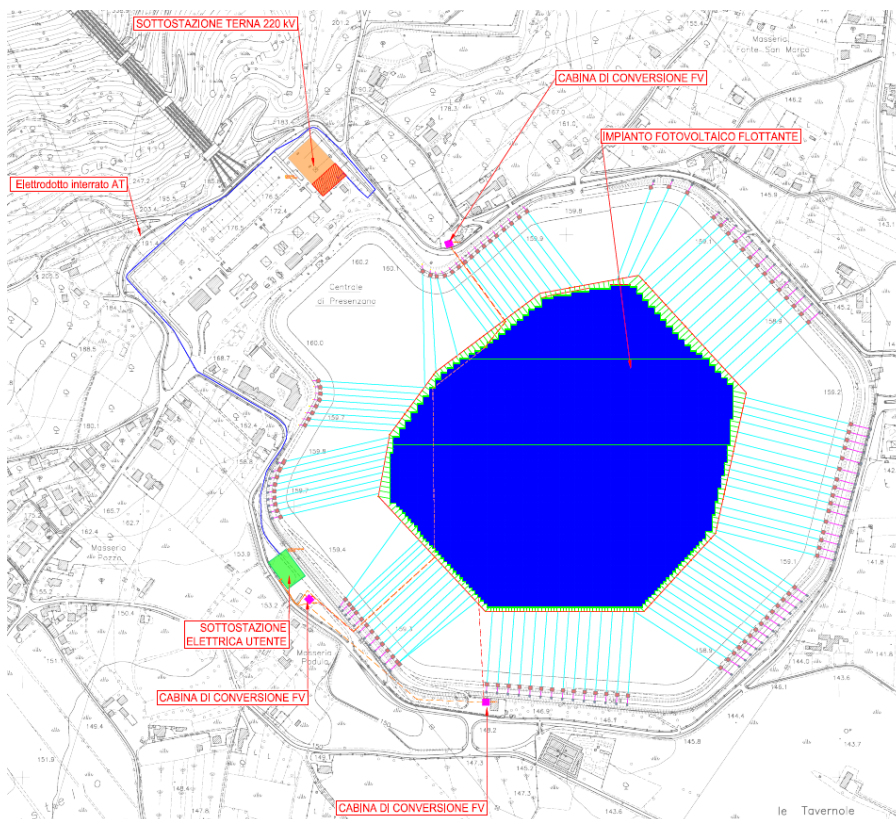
Layout su CTR per Progetto Definitivo di impianto e connessione alla RTN
